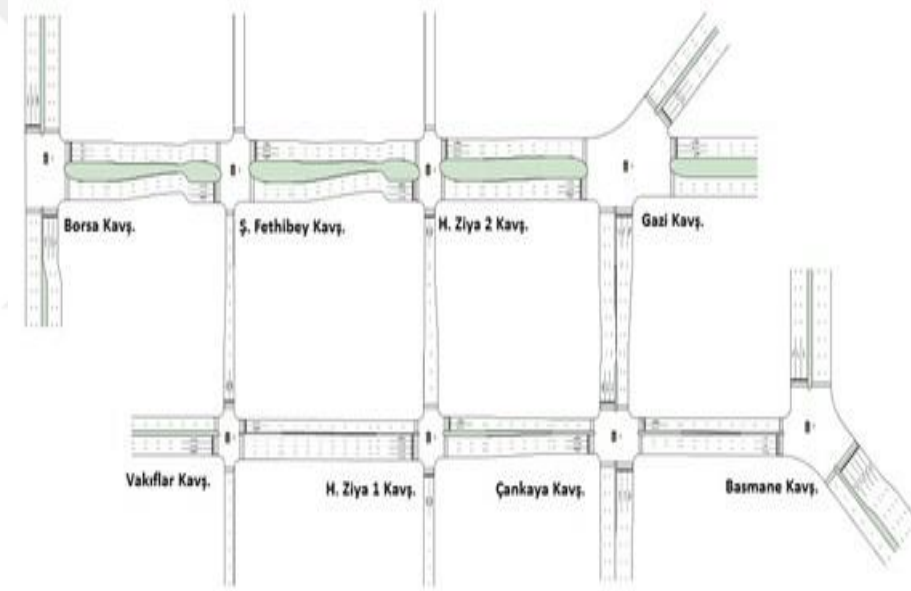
Borsa Kavşağı çift yön sistem ve faz planı
